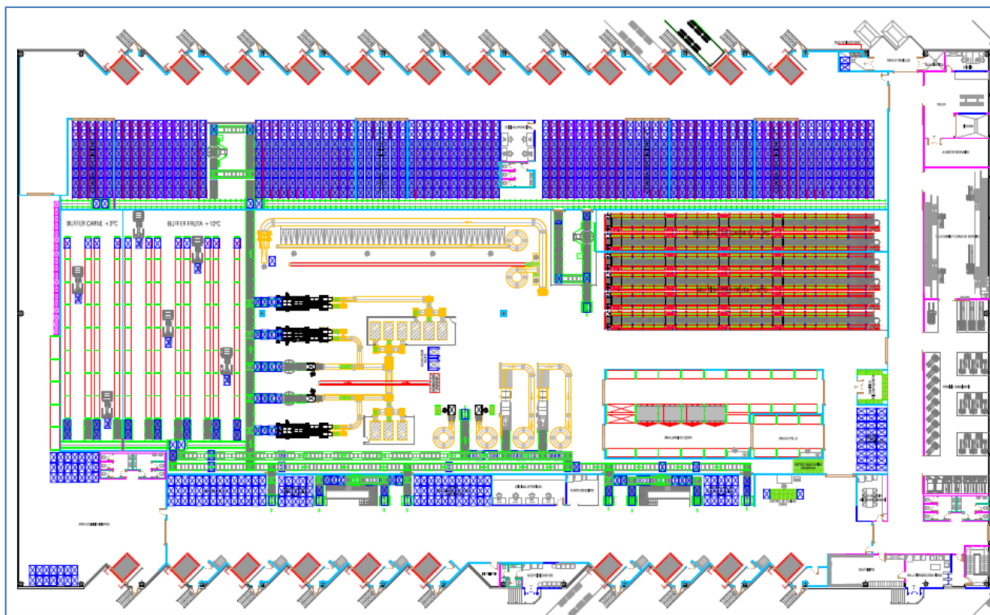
Lay out general escenario automático- Planta baja Fuente Elaboración propia
